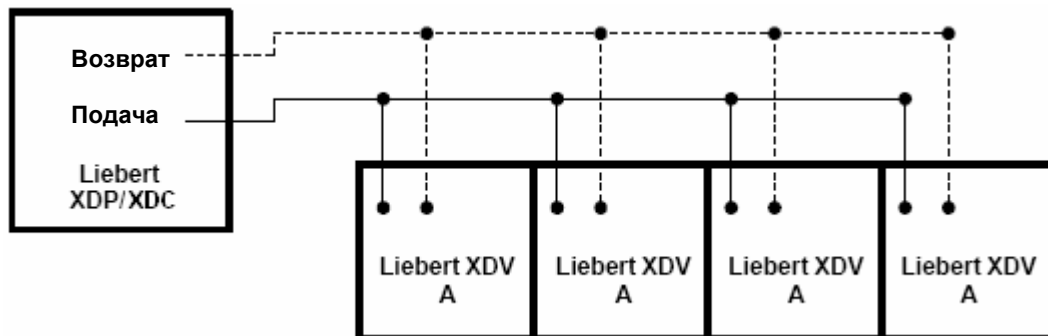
Типовая схема трубопроводов Liebert XDV –соединения без чередования
